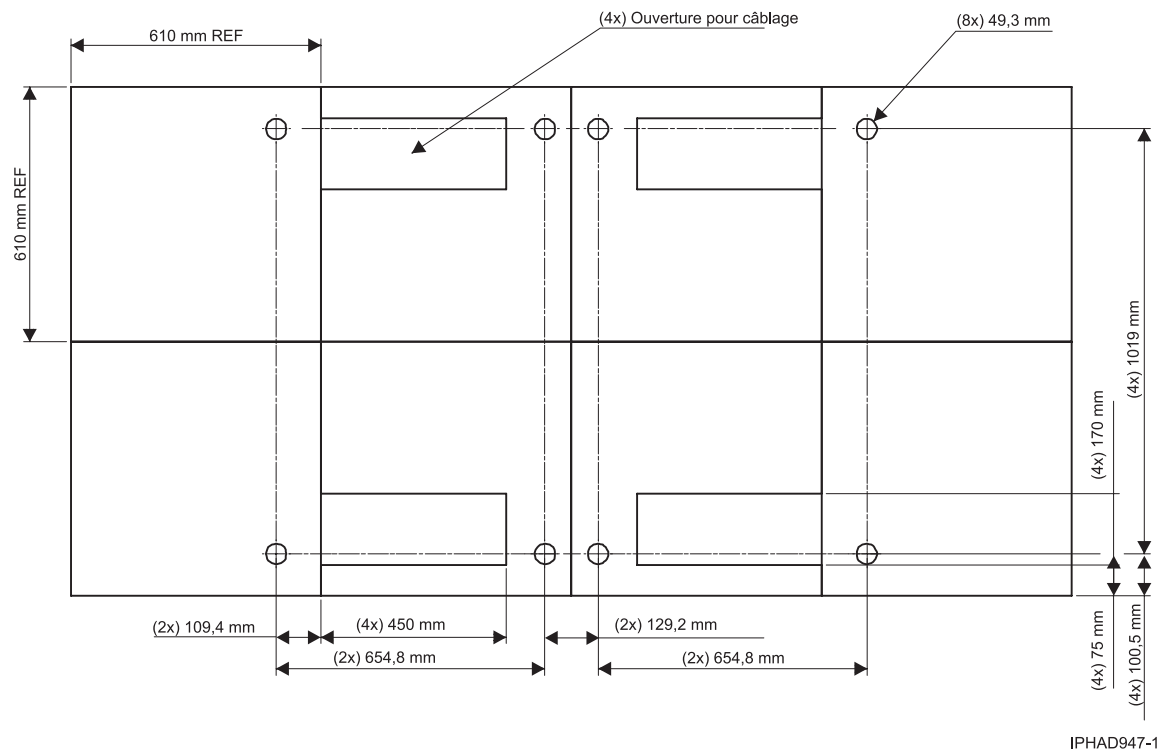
Positionnement des boulons à oeil pour dalles de plancher de 610 mm
